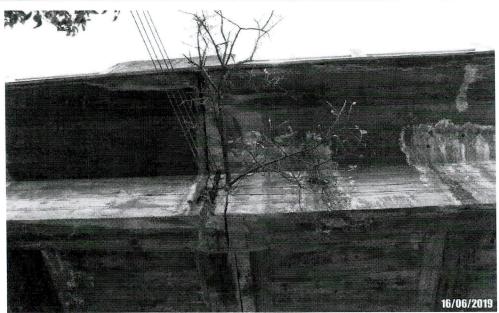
Detalhe da viga principal com vegetação, infiltração, eflorescência, desplacamento de concreto na viga principal.
